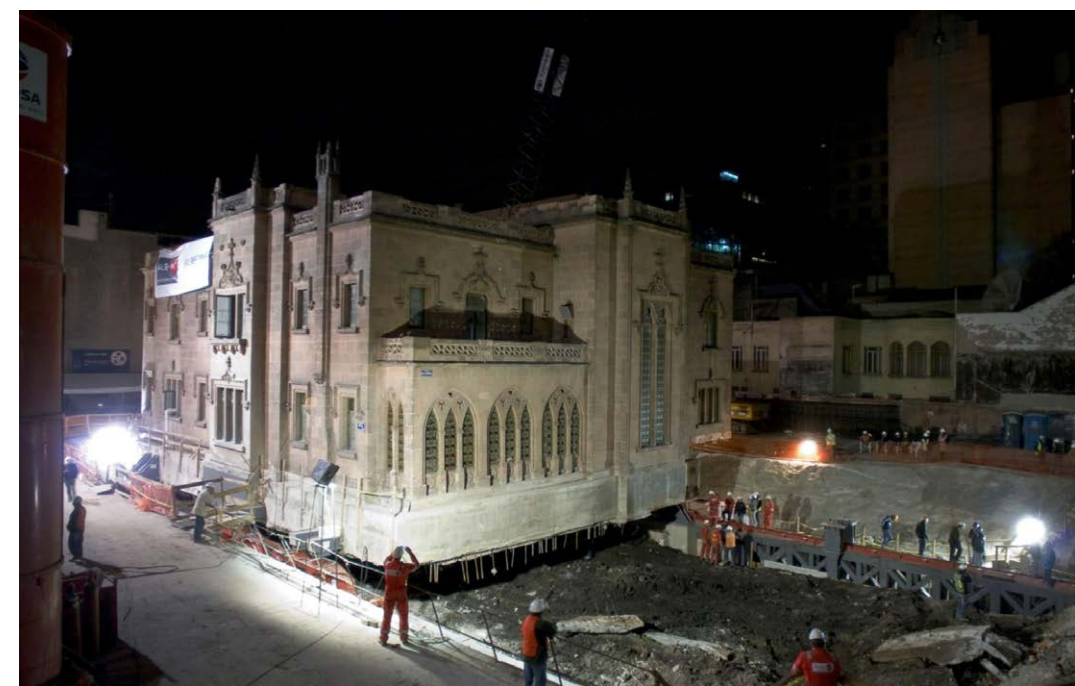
La casona desplazada 18 m hacia el fondo del predio, habiendo deslizado sobre muros Milán y Armaduras metálicas.
